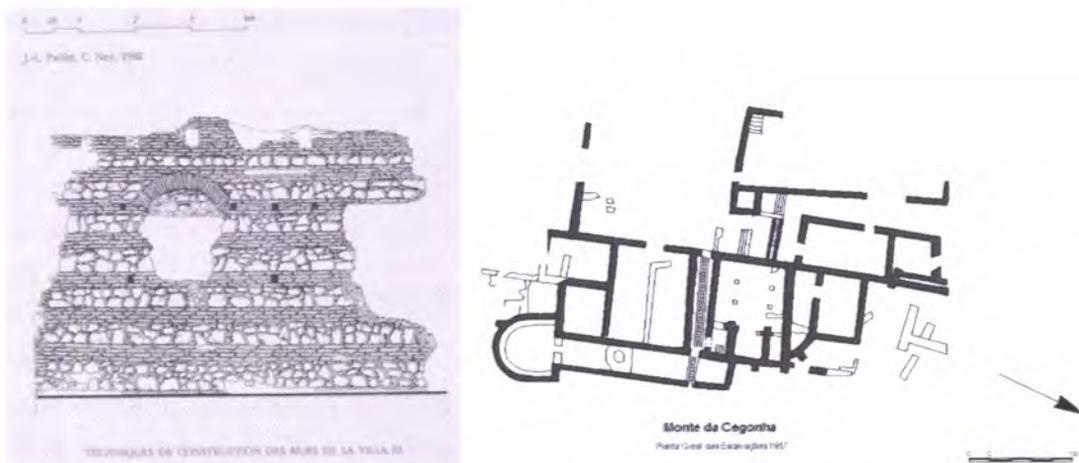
1 e 2; Aparelhos construtivos das paredes da *villa III* de S. Cucufate¹⁶⁰ e Monte da Cegonha, Selmes (Planta CMV)
